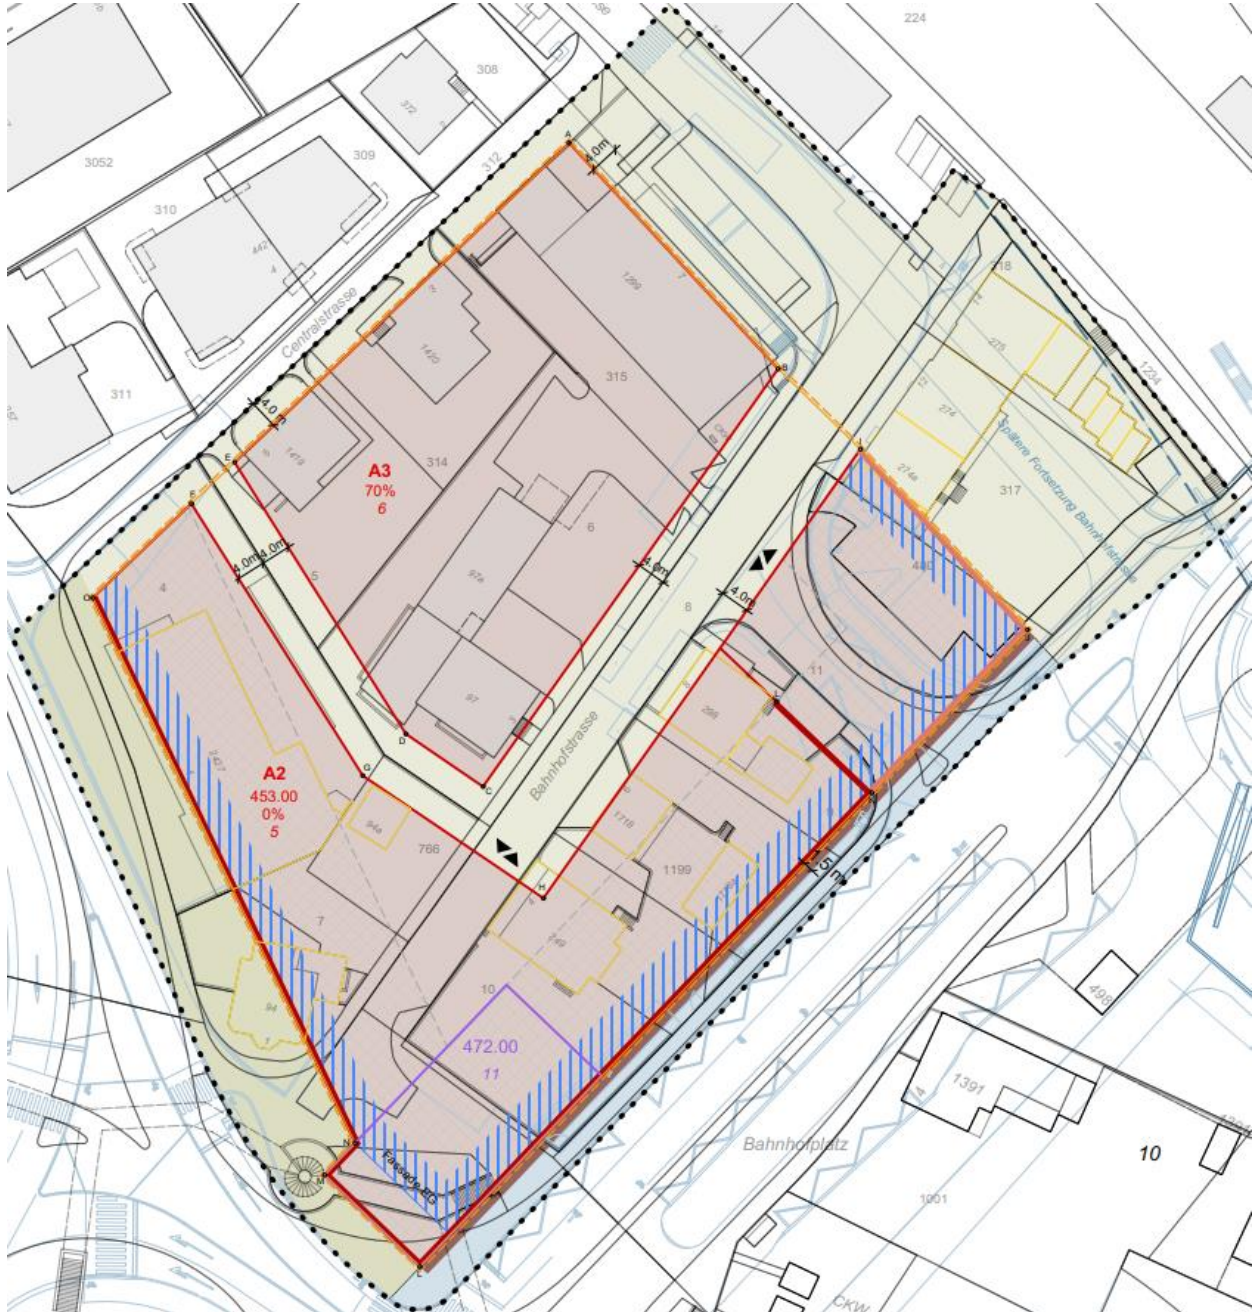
Auszug Situation aus dem Bebauungsplan «Bahnhof Nord, A2/A3»
